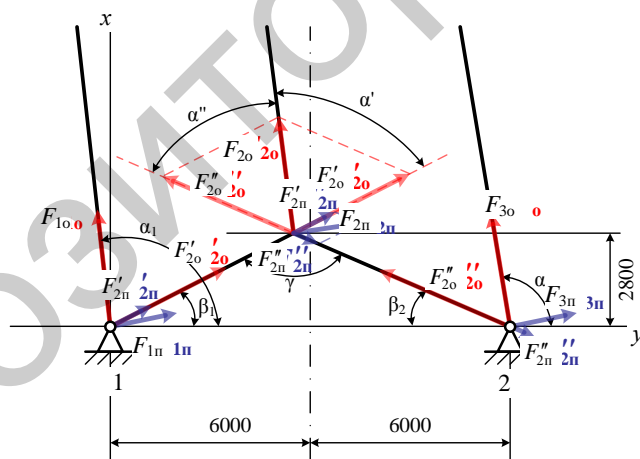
Поясняющая схема к определению нагрузок на опоры
